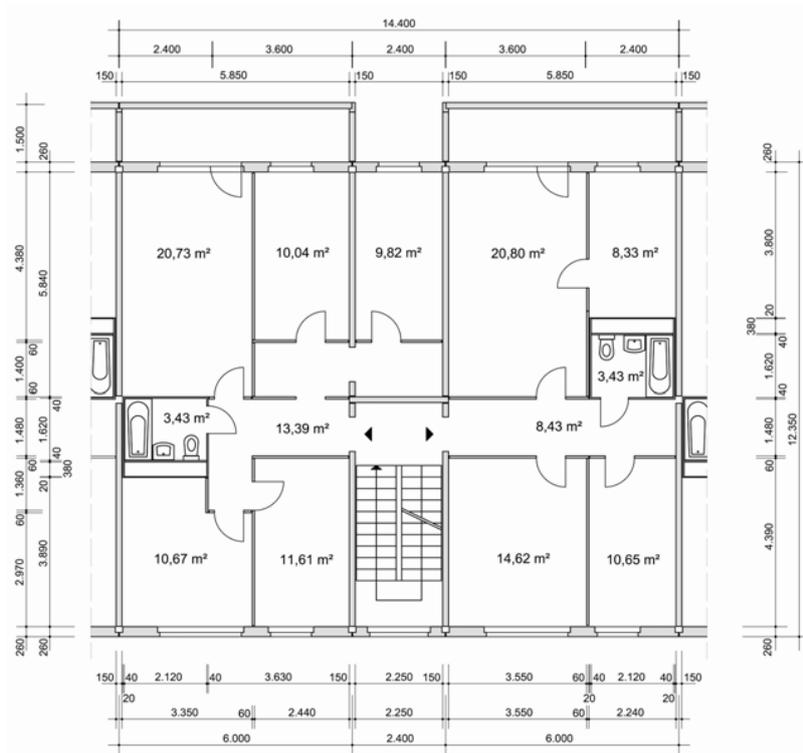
Grundriss Normalgeschoss – Segment der Plattenbauserie WBS 70¹⁸
